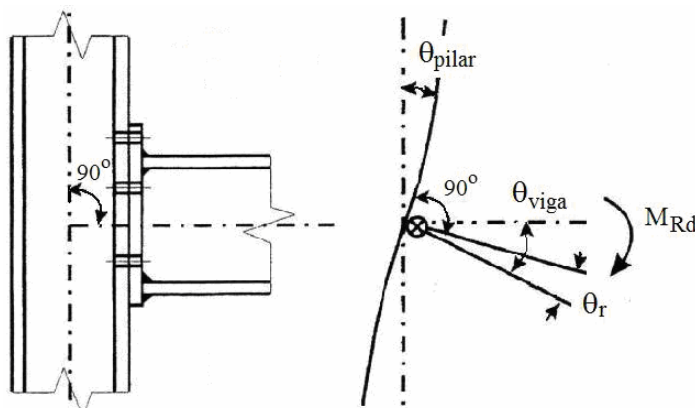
Rotação de uma ligação metálica viga-pilar
